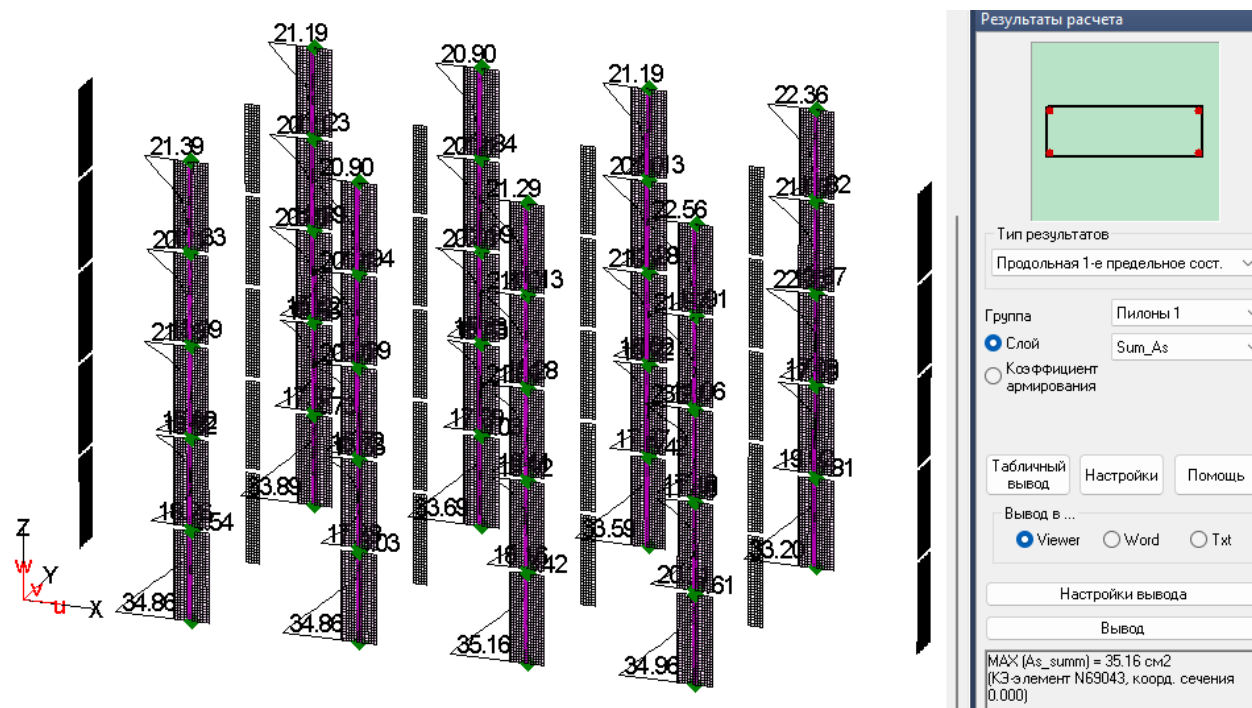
Значения эпюр арматуры в некоторых колоннах (Схема с использованием оболочечных элементов стен по нормам Еврокода).
